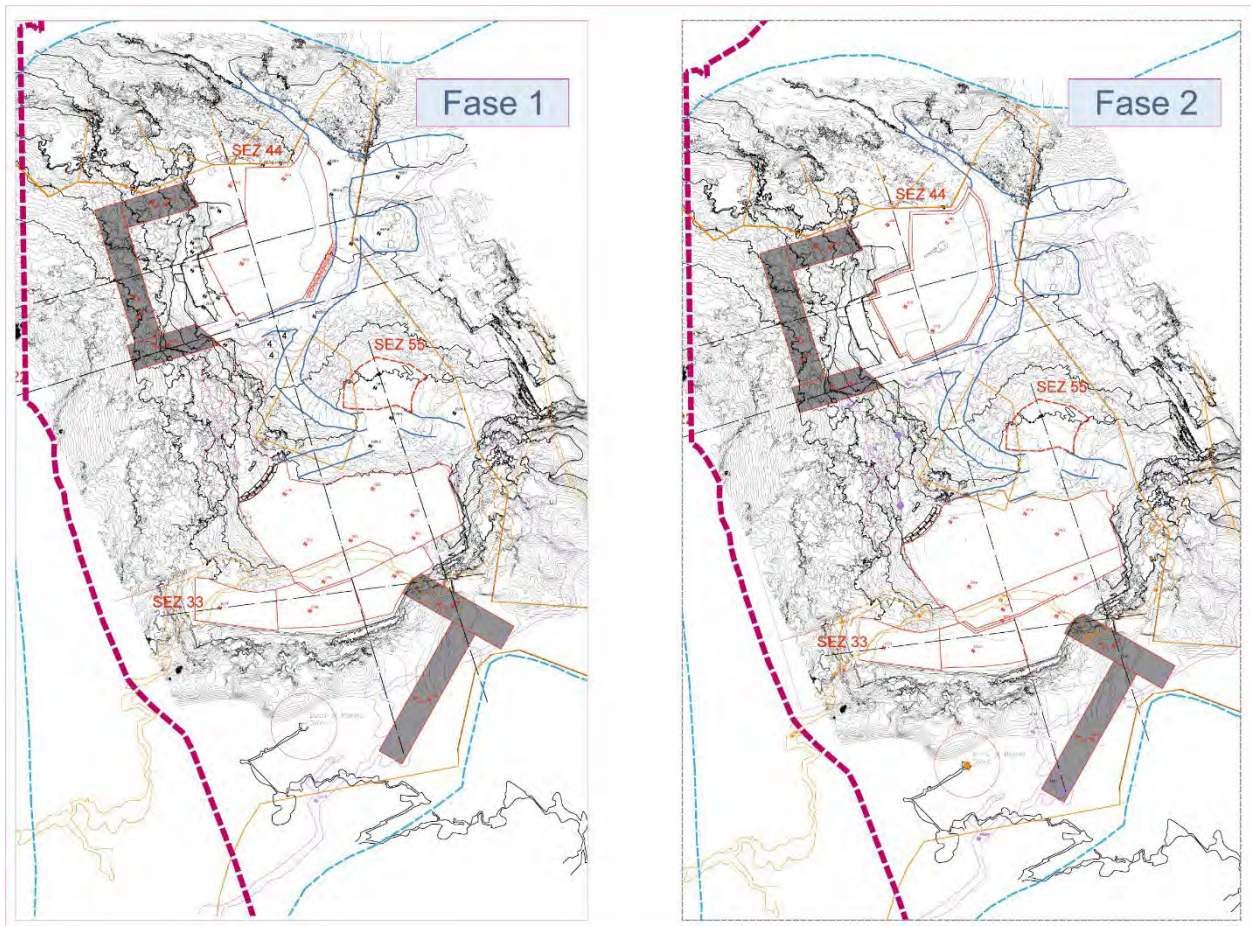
Estratto dalla cartografia di progetto: planimetria della Fase 1 e della Fase 2
